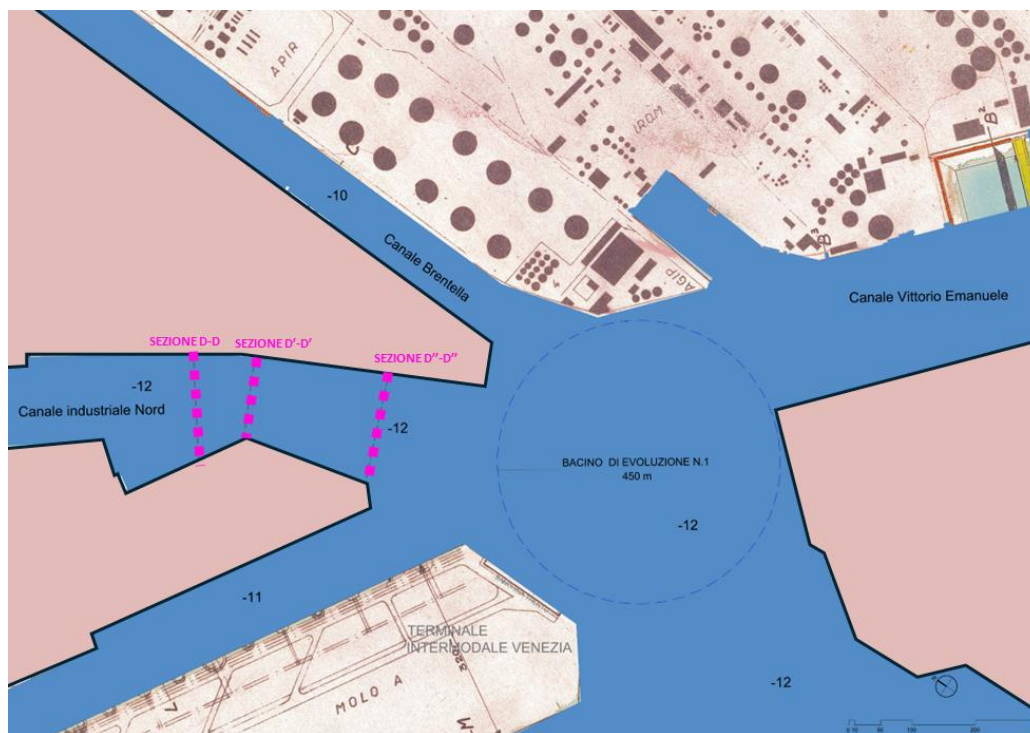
Planimetria del PRP aggiornato con ATF 2025 Marghera Nord e sezioni.
